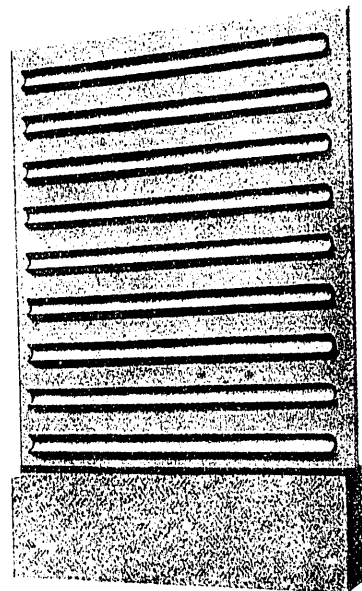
Plancha de palastro para la construcción rápida de casetas y cobertizos con «Torkret».
